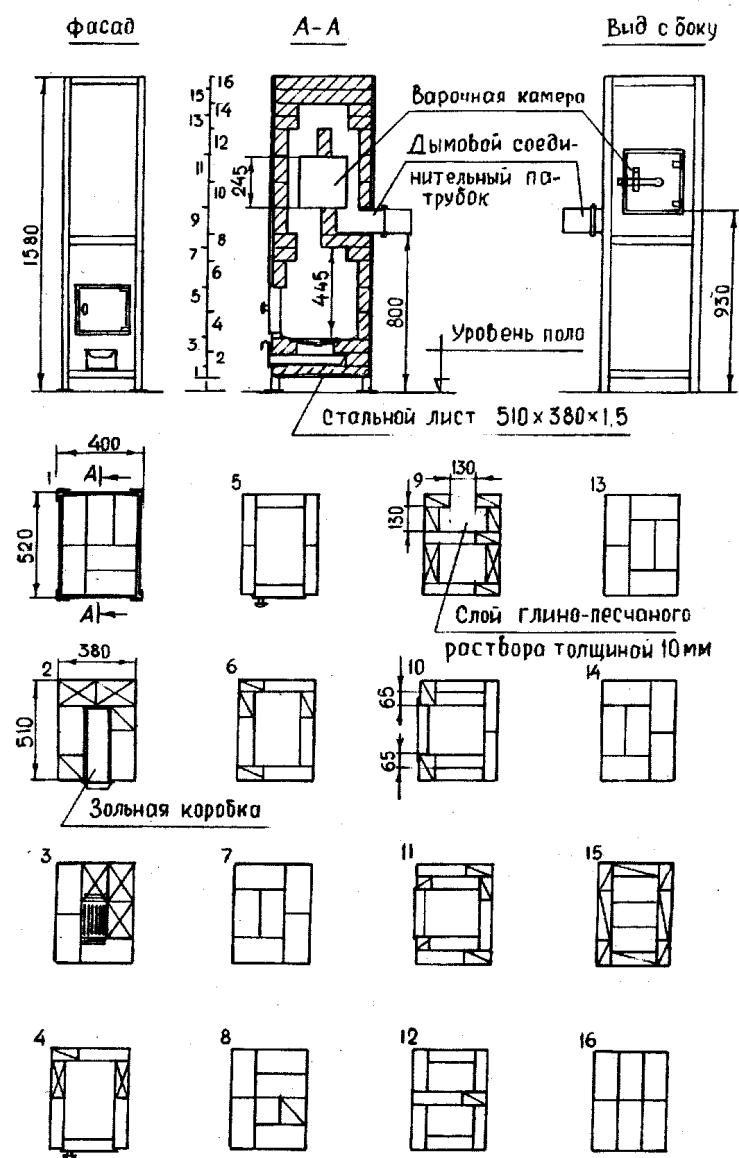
Кладка каркасной отопительно-варочной печи с боковым расположением варочной камеры
